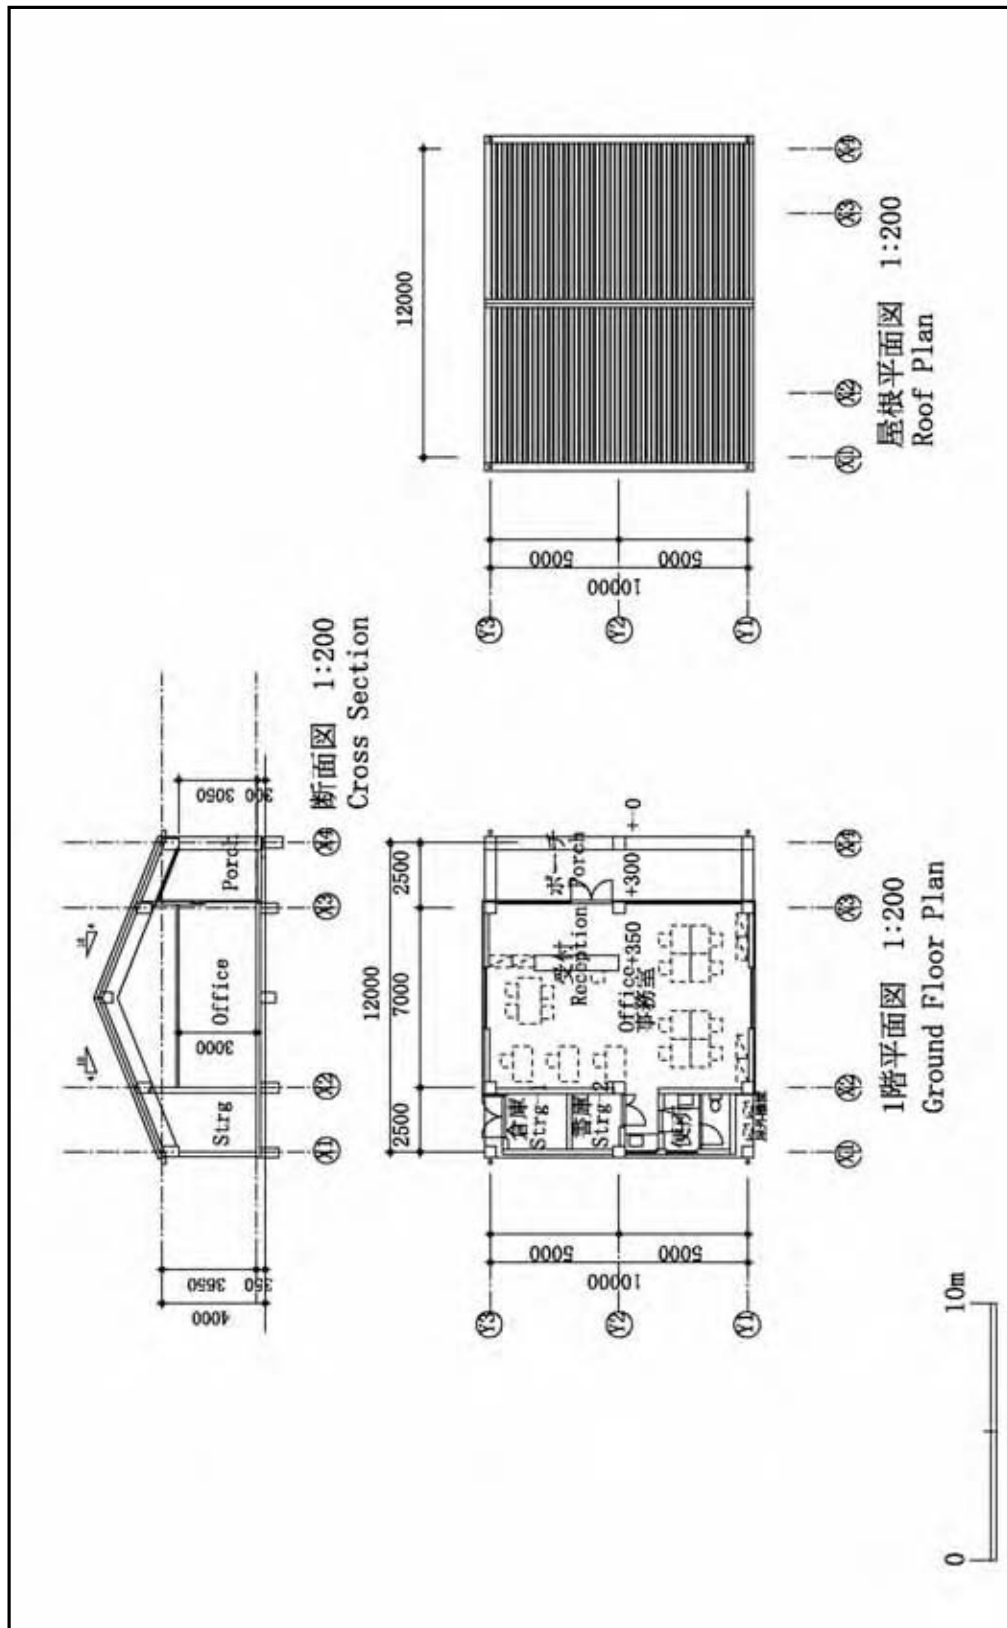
(23) 渔港事务棟平面図・断面図・屋根平面図
